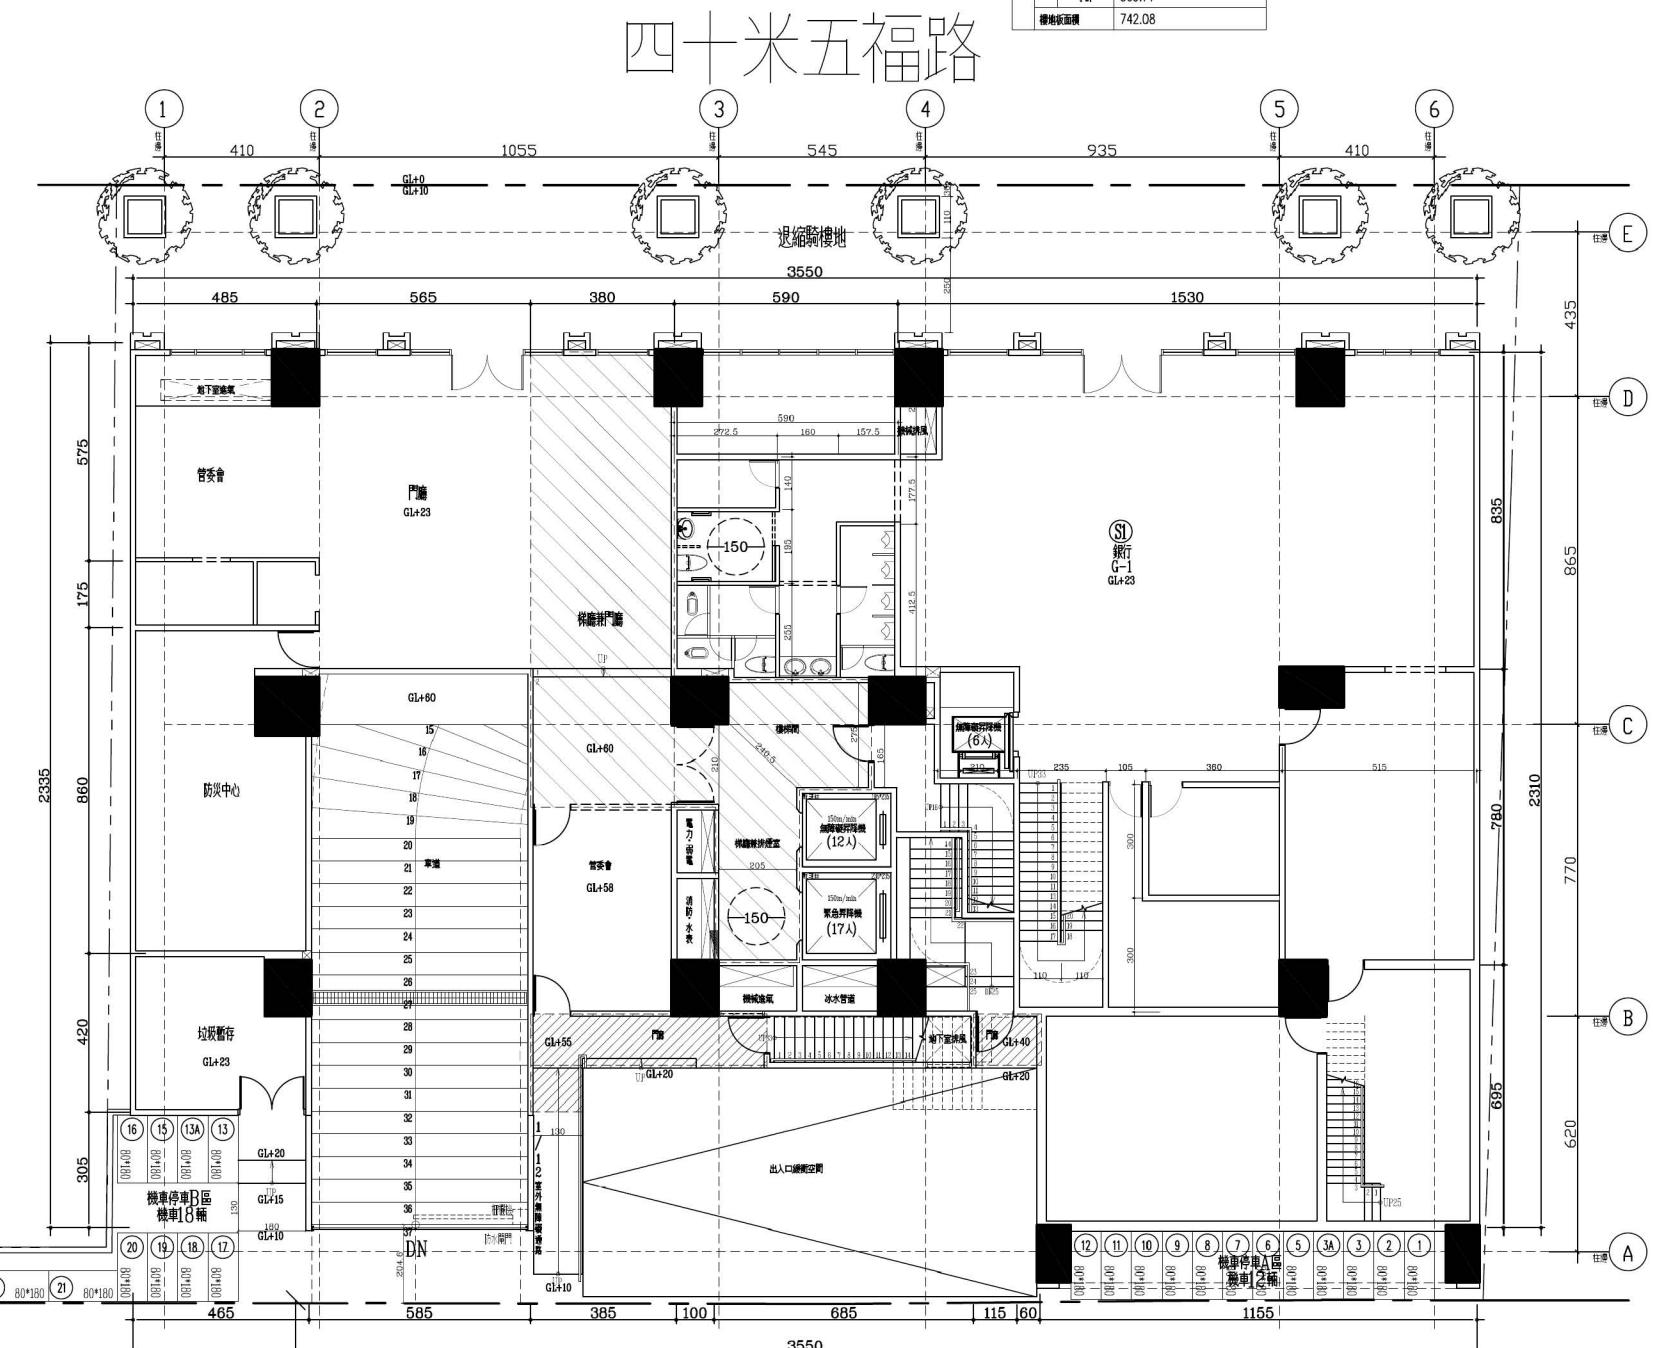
地上 1 層平面圖 (比例尺 1/200)
